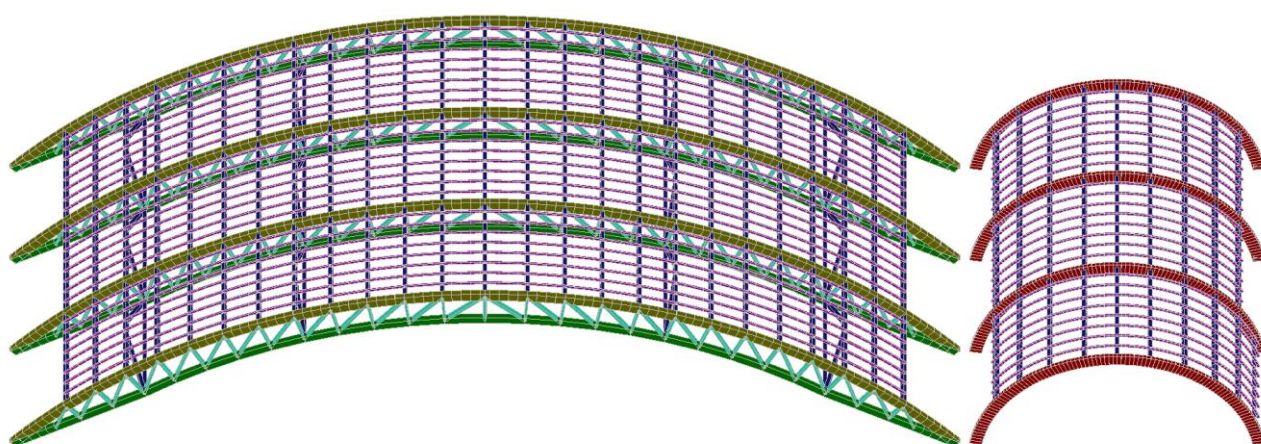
Фрагмент расчетной схемы, включающий покрытие
